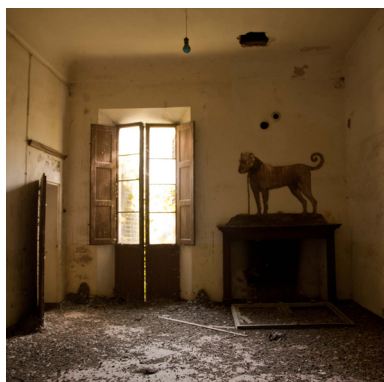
Vista della stanza pur troppo infestata di piccioni, come si può vedere dall'ingente guano sul pavimento.
